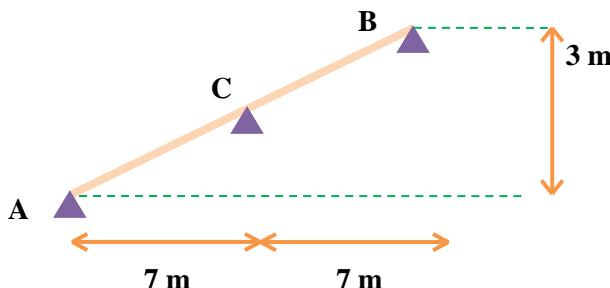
16 Sketsa Denah Lantai B1 Area *Ramp
